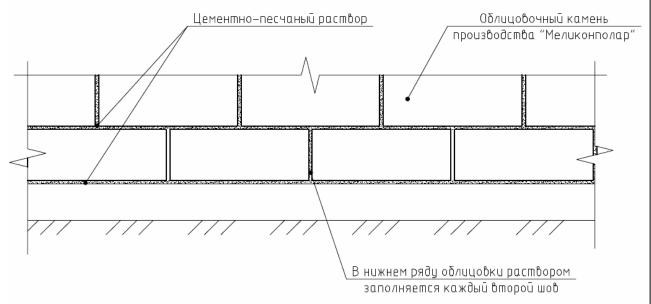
Фрагмент кладки нижнего ряда облицовки.
